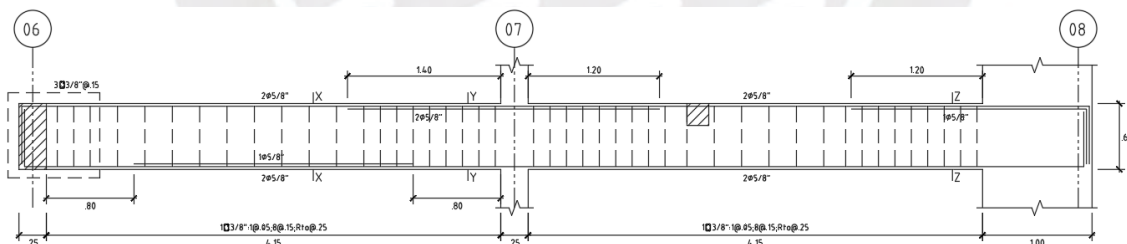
Detalle de refuerzo a flexión de viga V-4.
